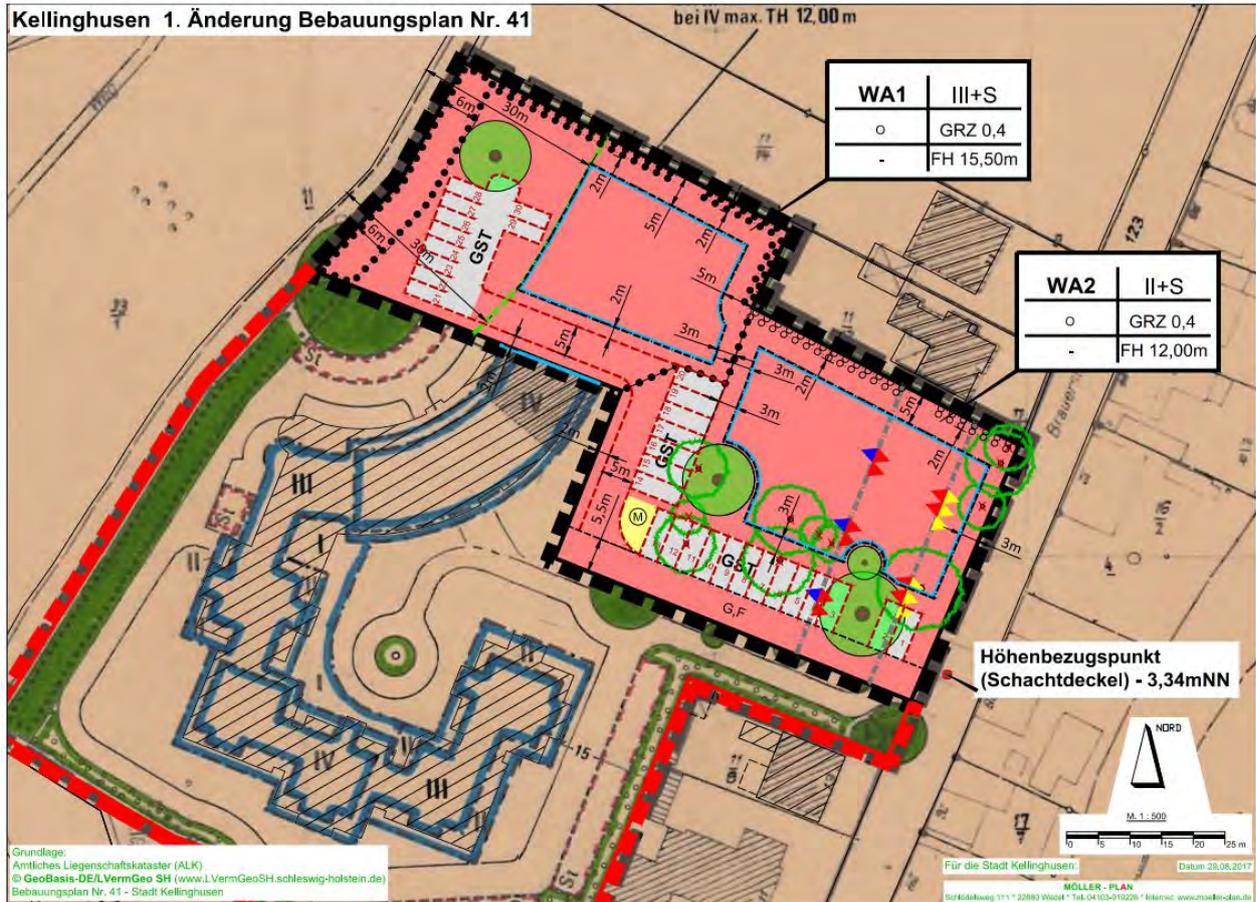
Entwurf 1. Änderung Bebauungsplan Nr. 41 der Stadt Kellinghusen (Büro Möller Plan: Lageplan, Stand 29.08.2017)
